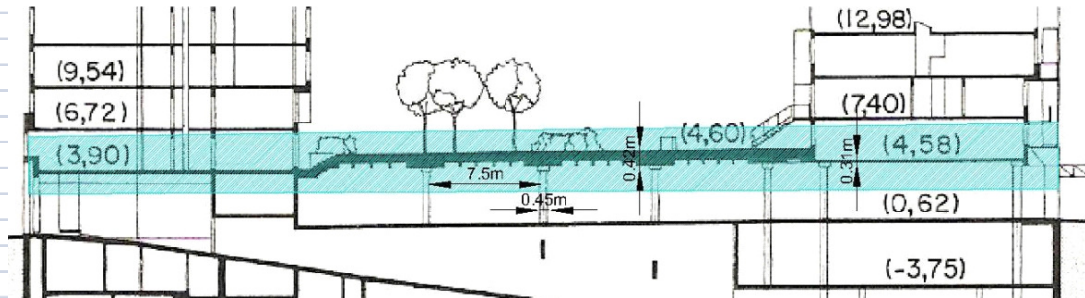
Sezione longitudinale dell'impalcato del primo piano
